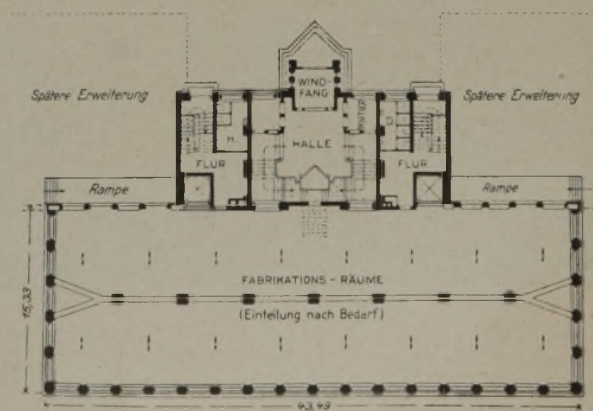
Grundriß Erdgeschoß. I. Baustadium.
